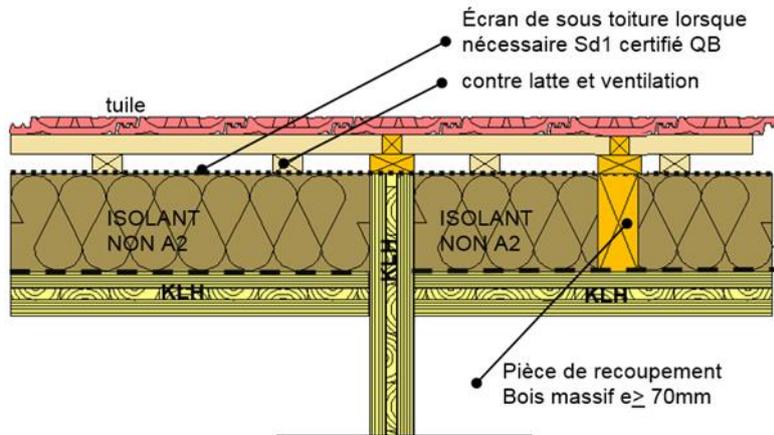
Détail de recouvrement au droit des écrans de cantonnement (simple mur)
